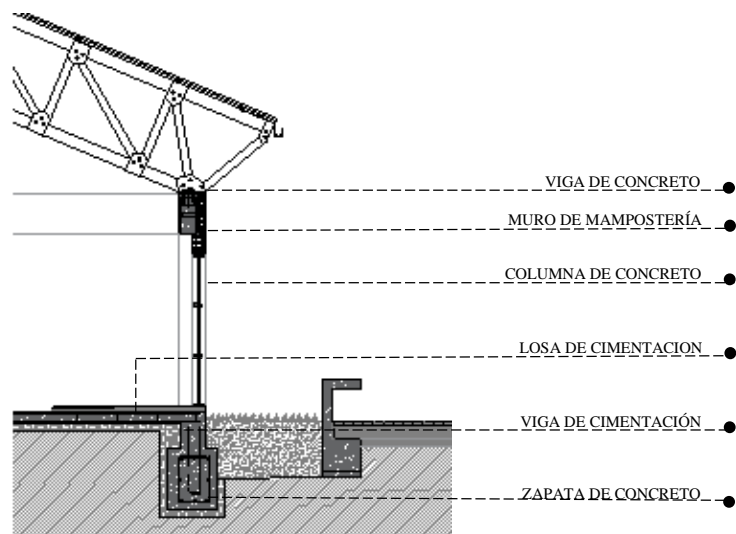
Corte constructivo tipo 2 - zona social. Fuente: propia.
